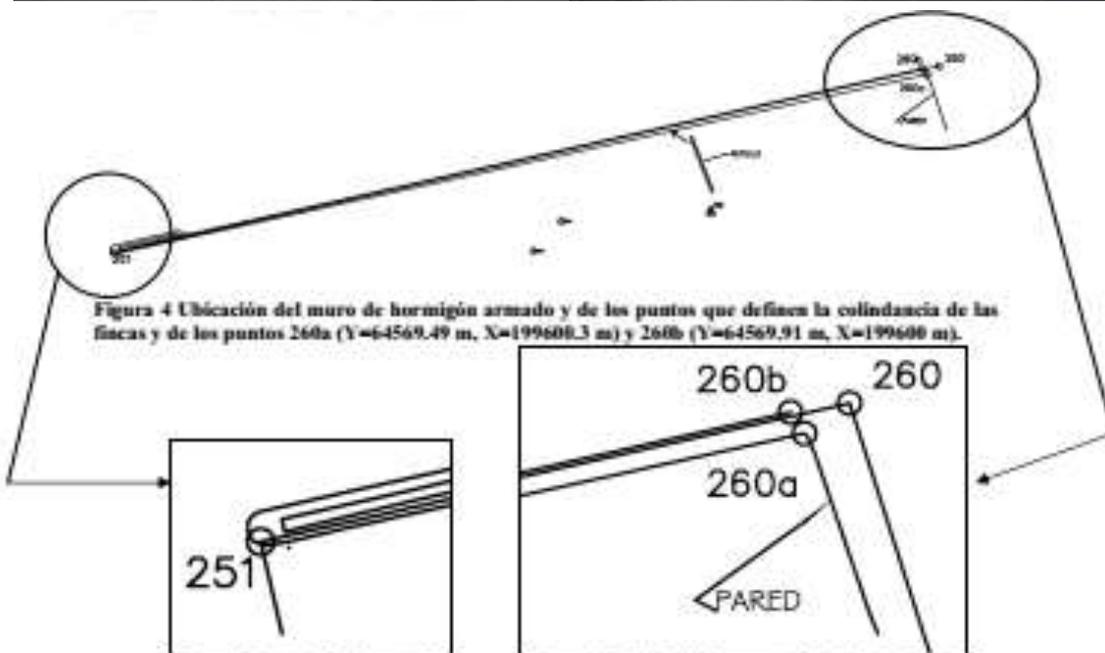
Ubicación del muro de hormigón armado y de los puntos que definen la colindancia de las fincas y de los puntos 260a (Y=64569.49 m, X=199600.3 m) y 260b (Y=64569.91 m, X=199600 m).
